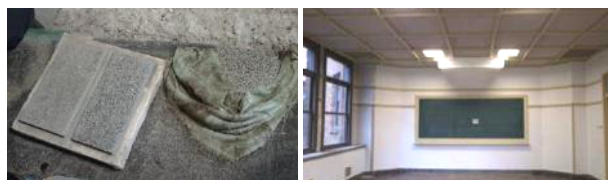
人造石研出し試験施工 写真-6 試験施工の部屋
